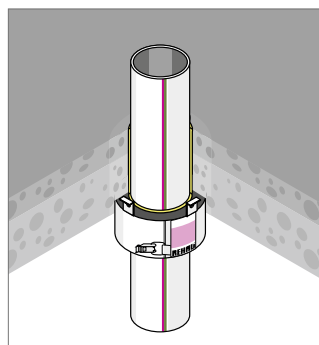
Противопожарная манжета для встраивания в перекрытие
